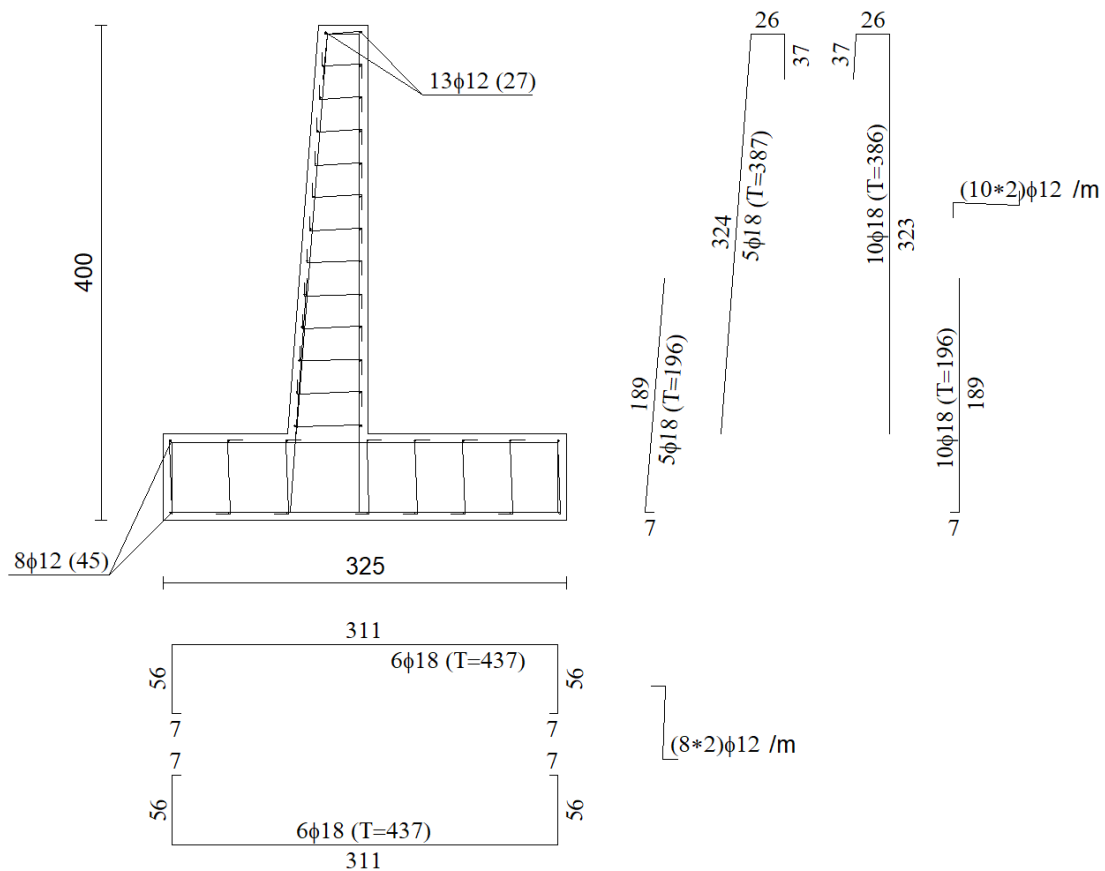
Armatura muro di sostegno Tipo 1 - Viabilità NV02B.
